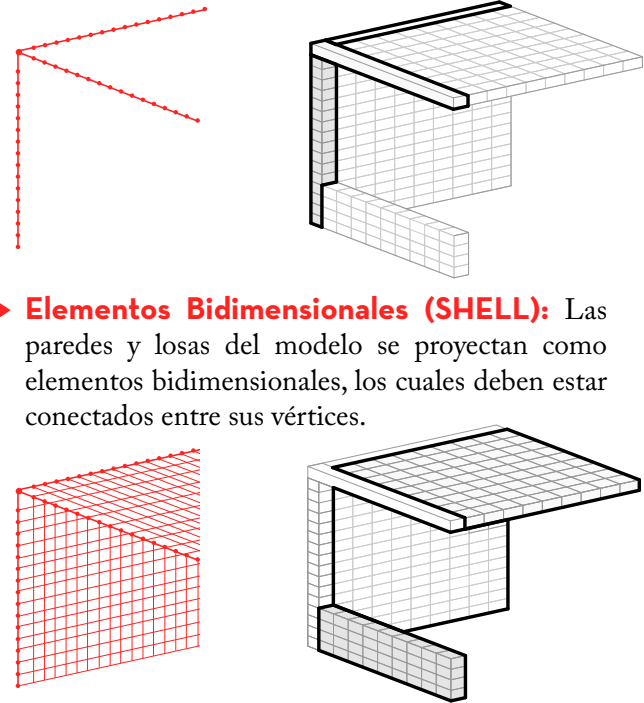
(A1) Elementos lineales: vista de modelo discreto y modelo BIM. (A2) Elementos Bidimensionales: vista de modelo discreto y modelo BIM.
